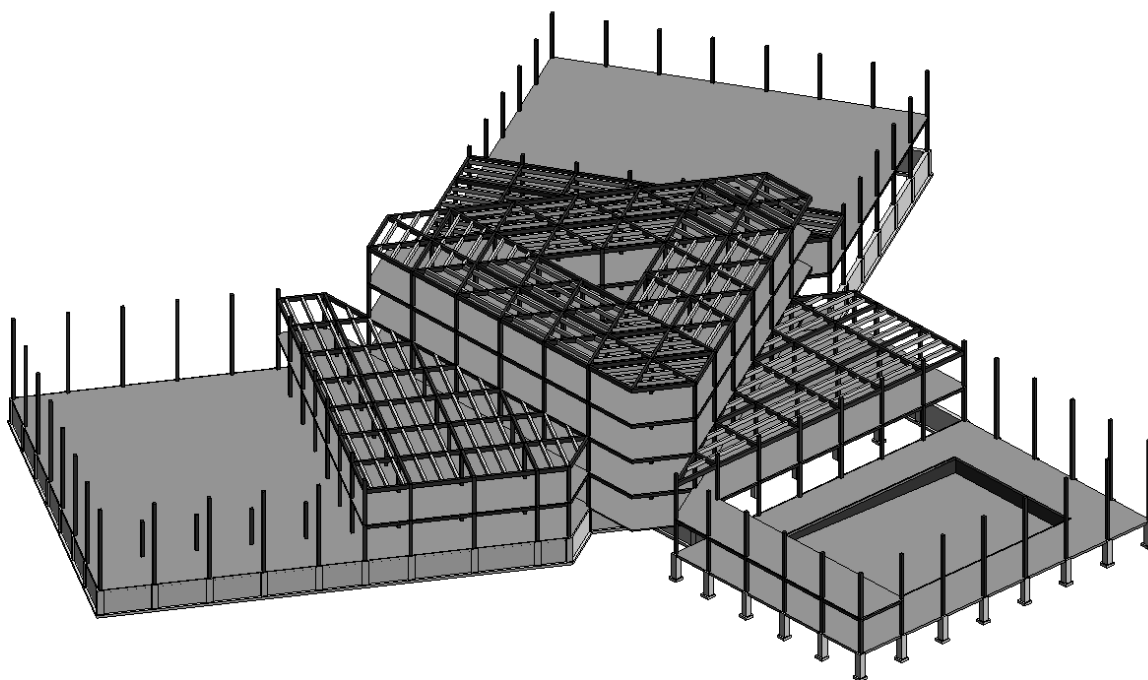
Конструктивна схема будівлі. Перспектива
